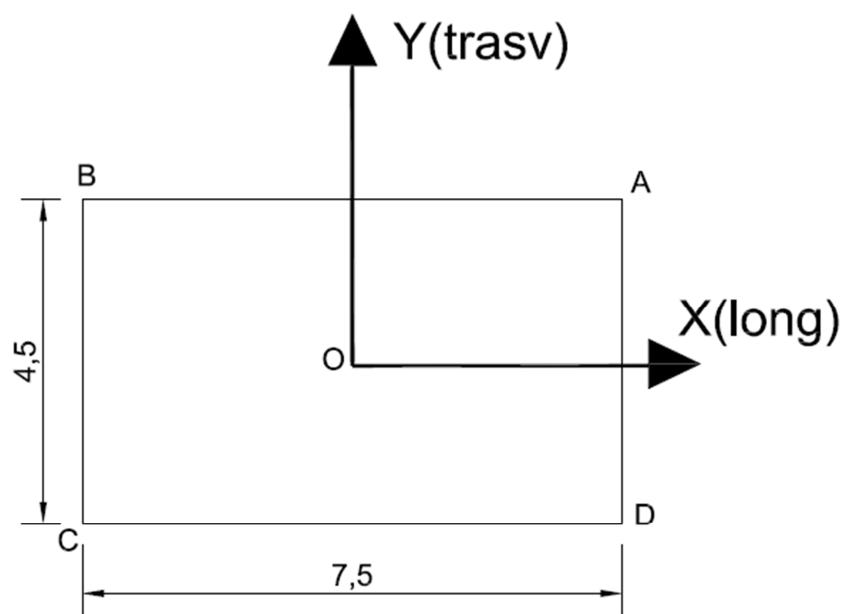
fondazione diretta pila (portale) 7,5x4,5 m
